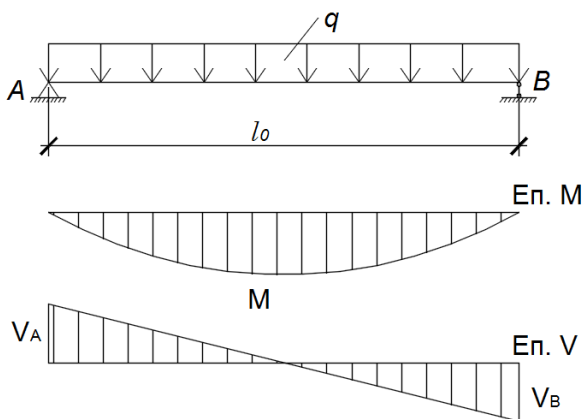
До визначення розрахункового прогону плити цивільної будівлі
